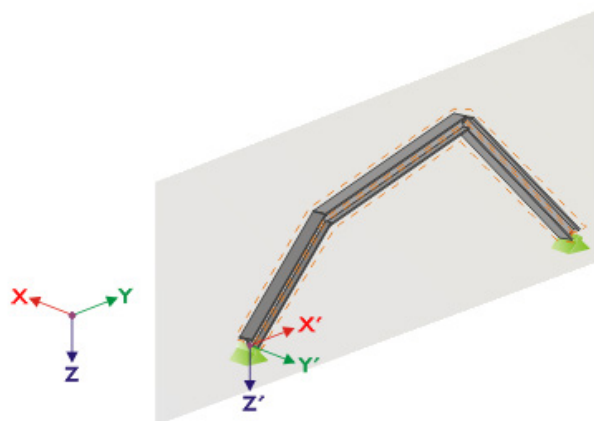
Sistema de coordenadas auxiliar para apoyos en nudos - conjunto de barras en plano vertical
